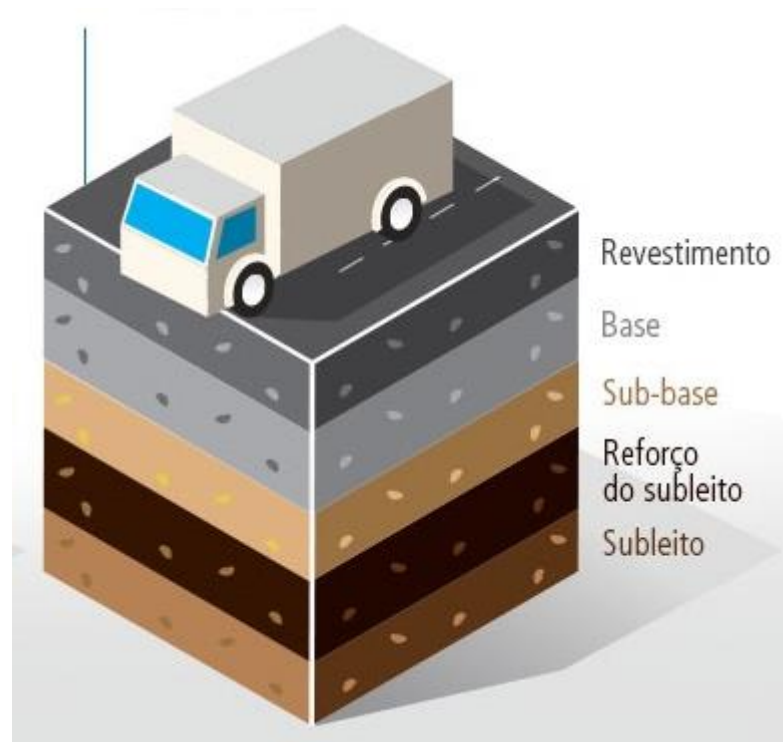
Pavimento Semirrígido com Sub-Base de Solo-Cimento
